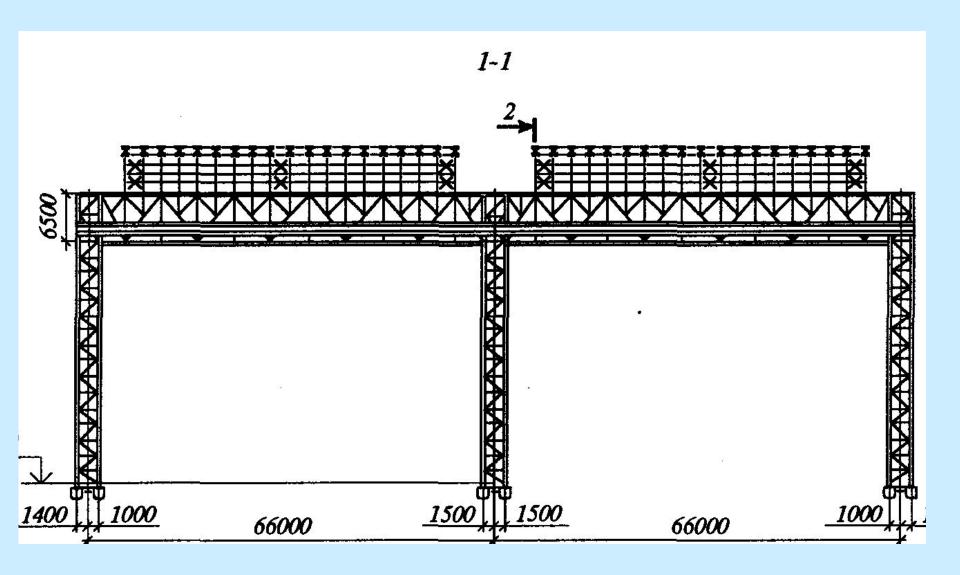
Двухпролетное здание пролетами 66 м с рамными несущими конструкциями
